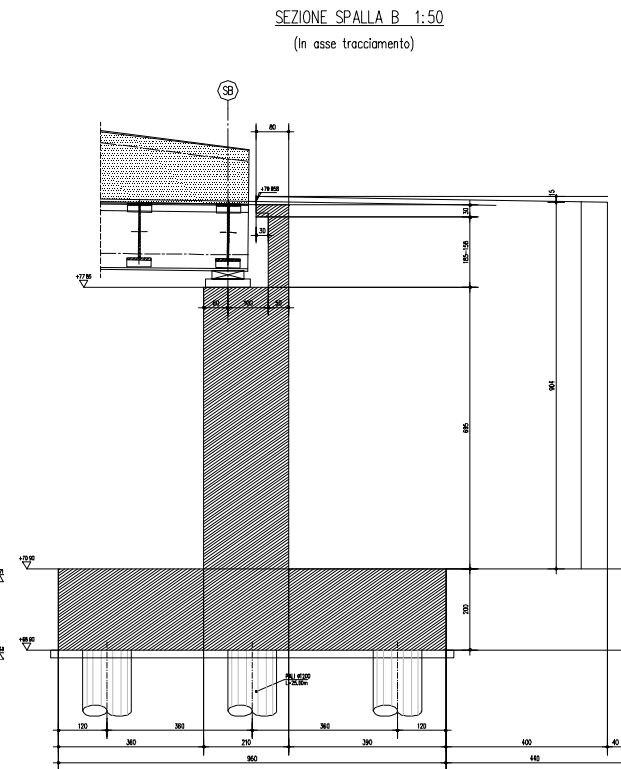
Spalla SB- Sezione trasversale
